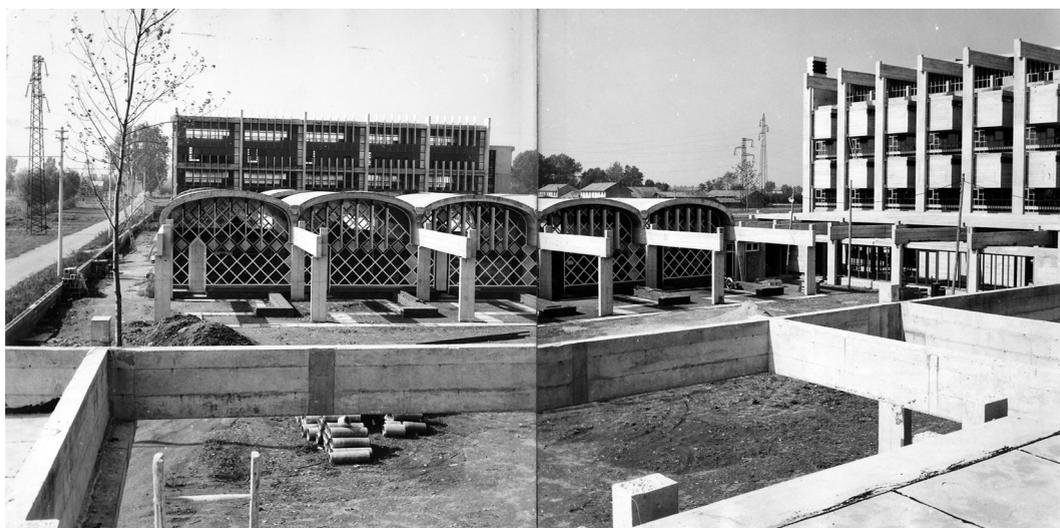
Vue du chantier de l'ensemble, août 1956, Archivio de Moderno.
